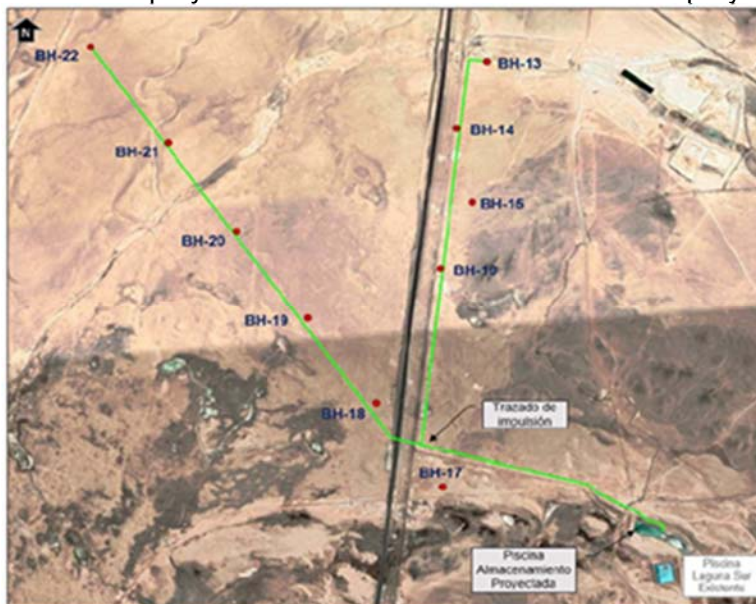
Disposición Pozos de Barrera Hidráulica – Pozos Muro Oeste proyectados (Referencial).
